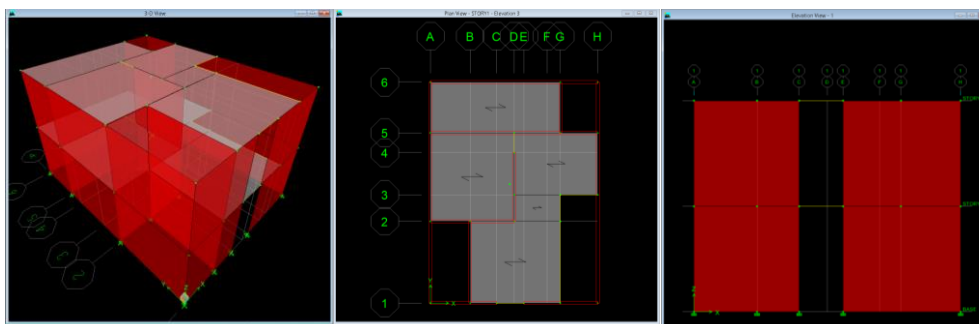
Vista en planta y elevación del modelamiento de la edificación 41
